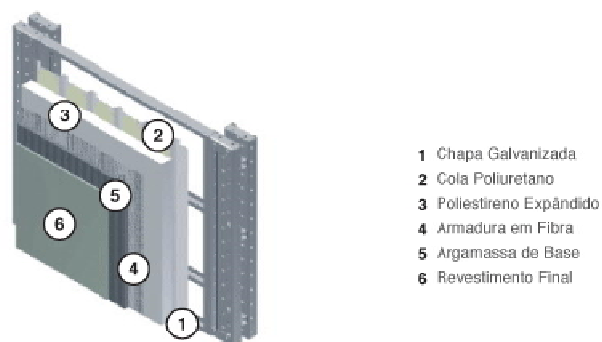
Pormenor construtivo de uma parede exterior (TÉKETO, 2010)
